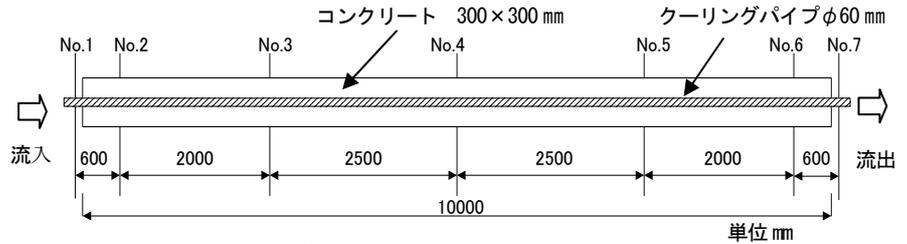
試験体 (No. 1～No. 7: 計測器設置位置)
